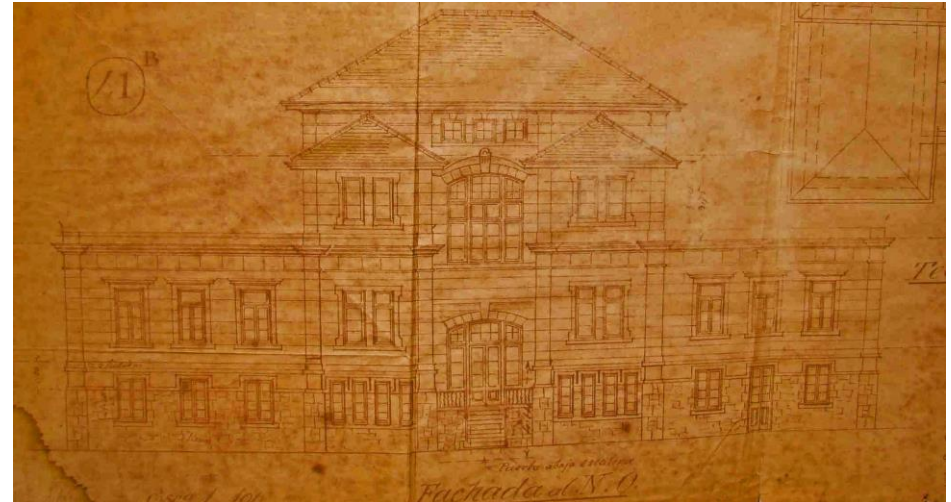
Fachada noroeste, 27-03-1918. Acervo: Clube Campestre.
